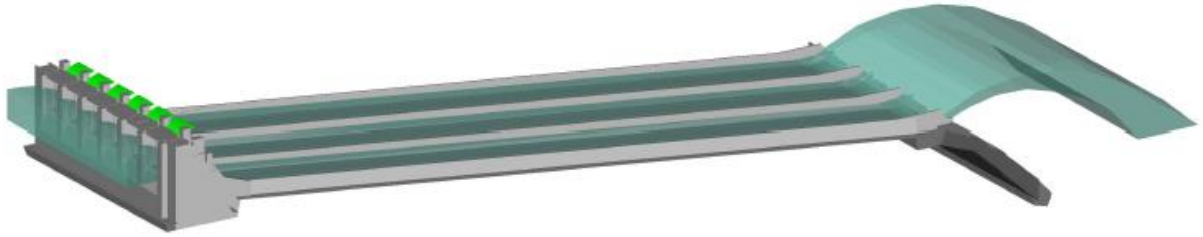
(devam) Ilisu Barajı dolusavak eşik yapısı ve Beton Baraj (Çelen vd. 2013)
